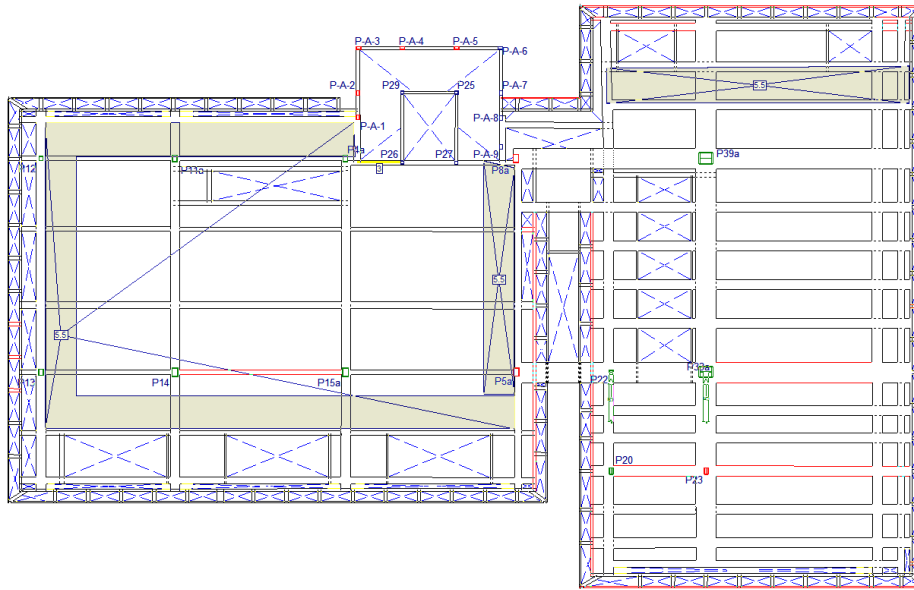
Sobrecarga de tierras en planta cubierta (modelo de CYPECAD).
